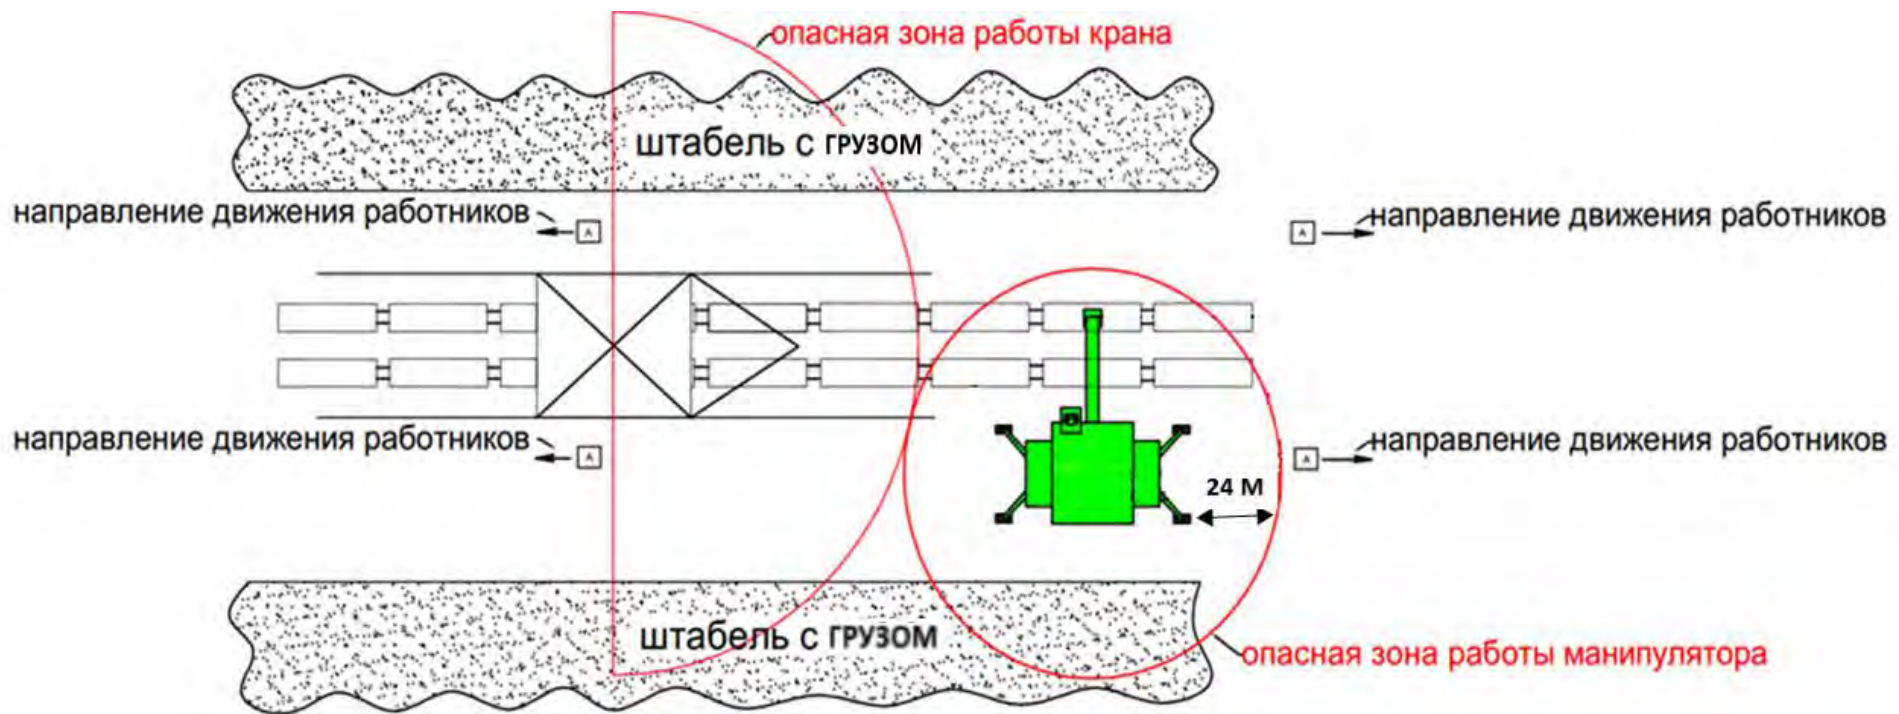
Схема выгрузки груза электропортальным краном и манипулятором
